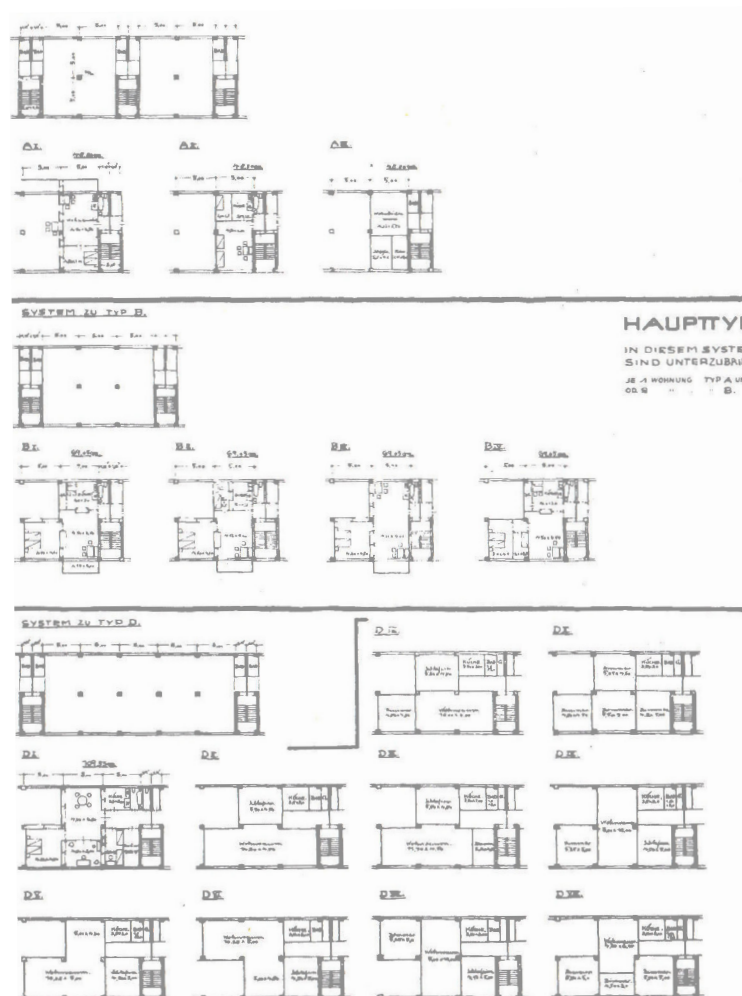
Adolf Rading, Entwurf "Elastische Wohnungen", Breslau Pöpelwitz, 1926, Grundriss M. 1:1000
